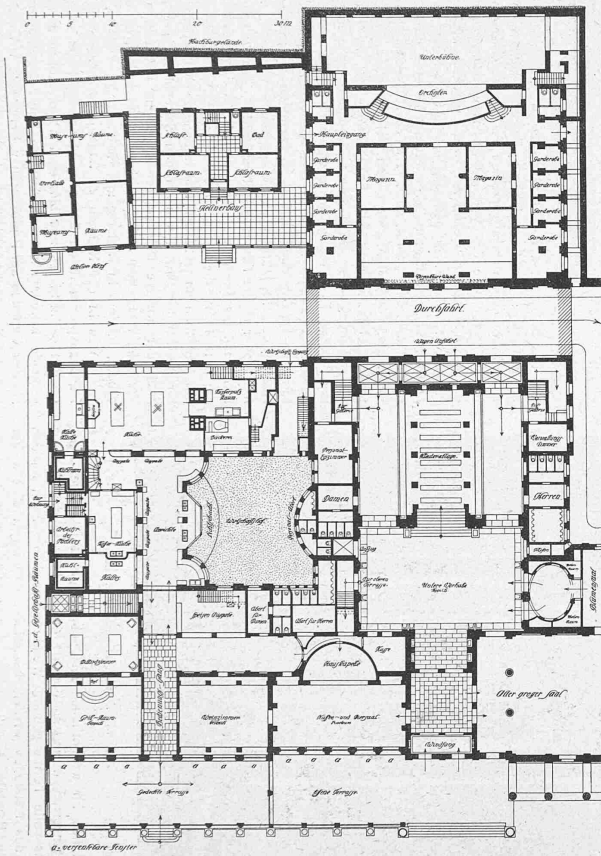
Erdgeschoss des Wirtschaftbaues und Untergeschoss des Saalbaues. — Grundrisse 1:600. — Abb. 10. I. Stock vom Wirtschaftbau und Hauptgeschoss vom Saalbau.
